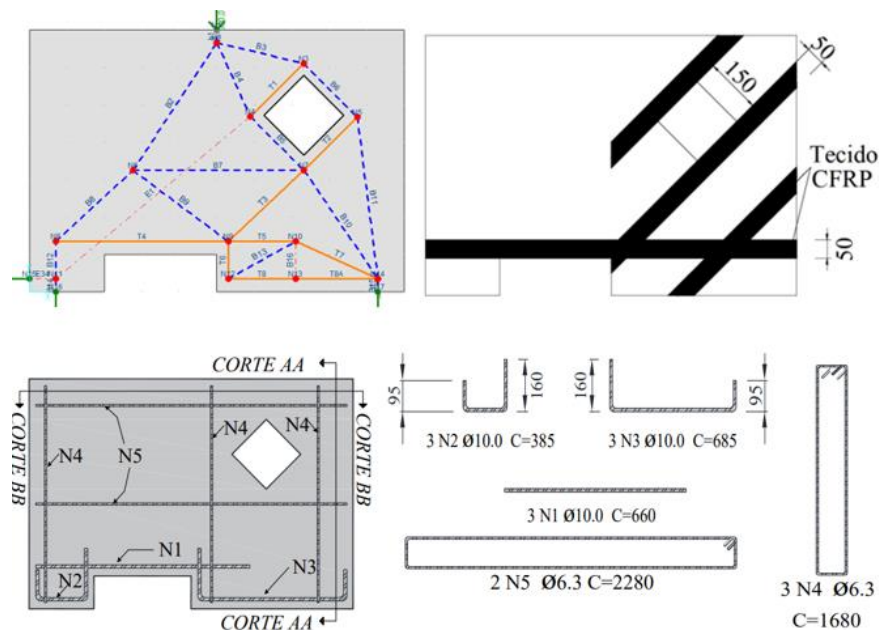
10 – Modelo de bielas e tirantes, armadura e reforço da viga-parede DB-H1-WR-S. Fonte: autor.
